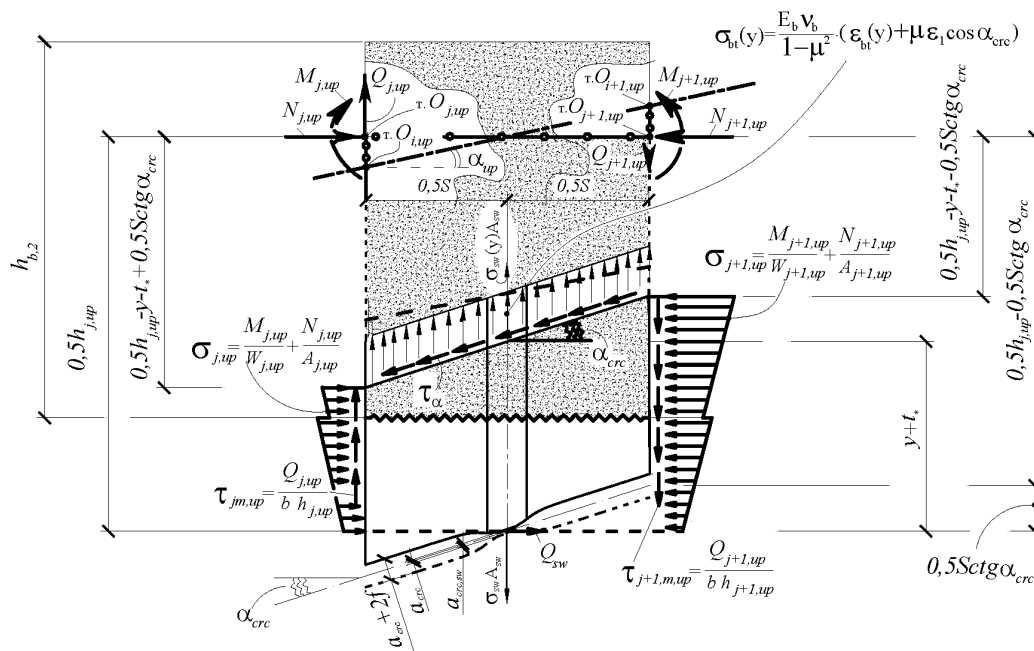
Расчетная схема к определению деформаций растянутого бетона $\epsilon_{bt}(y)$ между наклонными трещинами первого, второго и третьего типов в железобетонной составной конструкции
